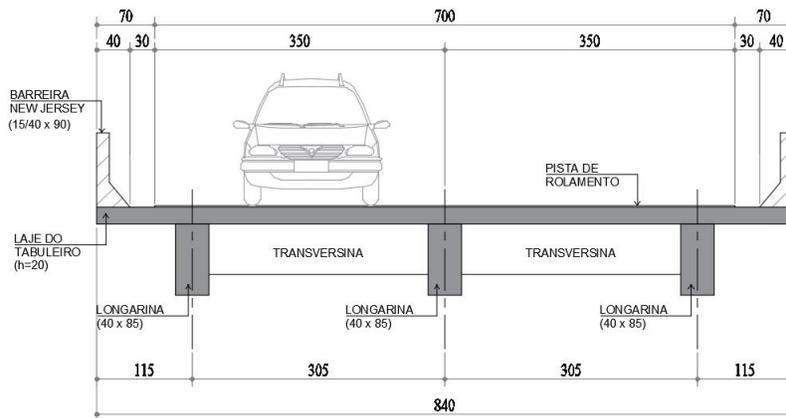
Croqui da seção transversal da ponte (medidas em centímetros)
